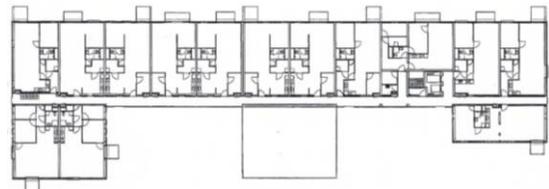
Planta de distribución. (Fuente: web "Plataforma arquitectura")
